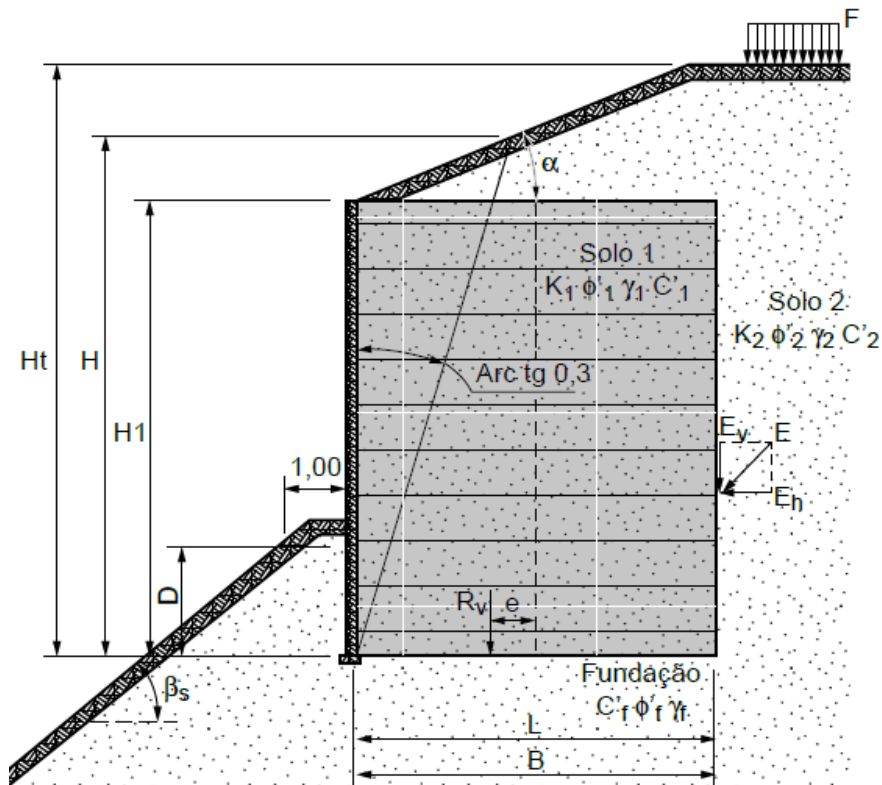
Notações utilizadas no dimensionamento dos muros em Terra Armada
